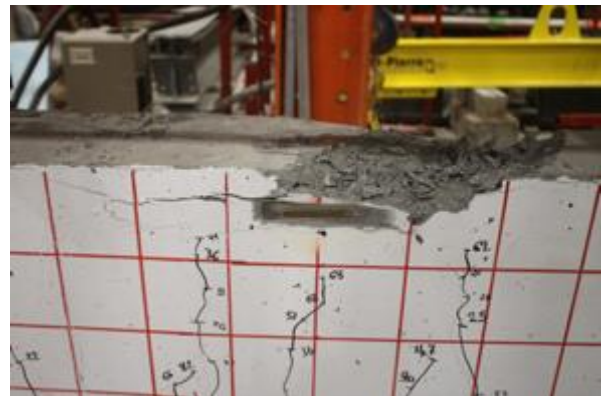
2^{ème} poutre P6-2 après rupture
